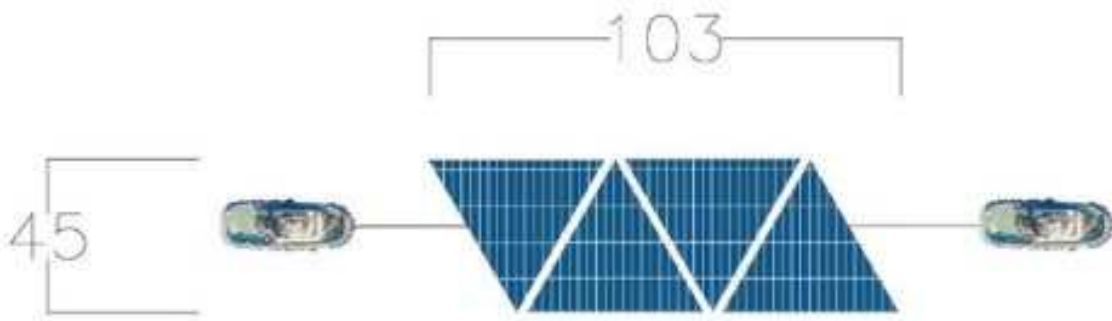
Rendering delle piattaforme in Progetto, rimorchiate
